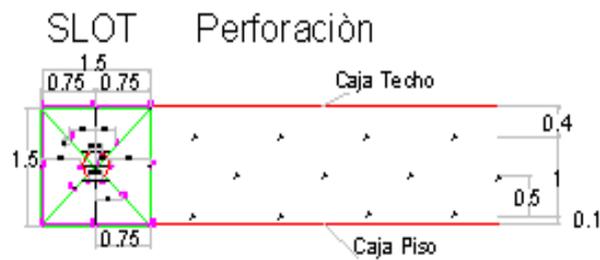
Malla de Perforación vista transversal y vista de planta.
